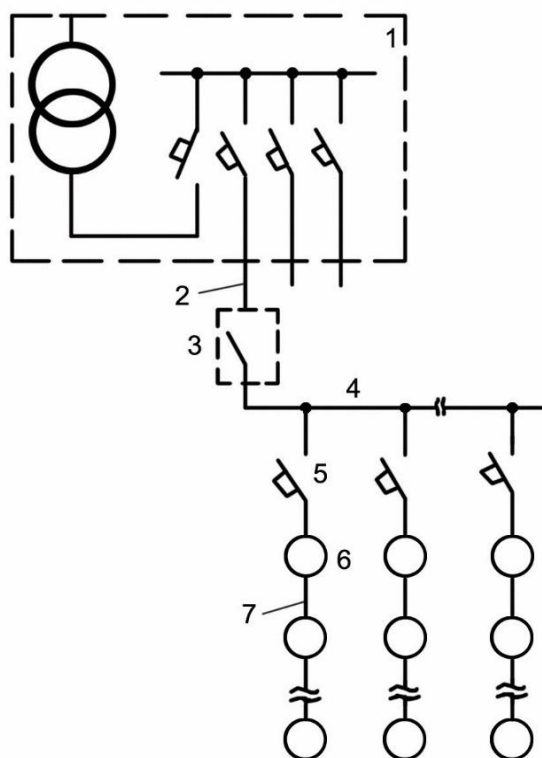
Схема питания рабочего освещения производственных зданий от распределительного шинопровода:
